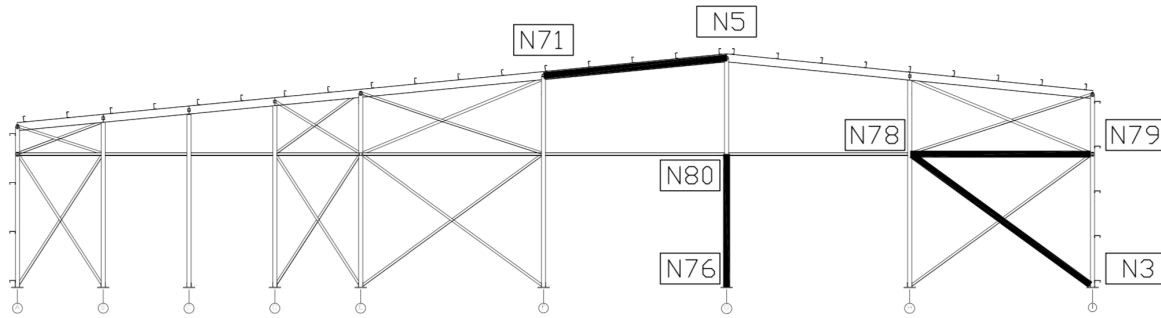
Barras comprobadas en el pórtico de fachada - Alineación 1
